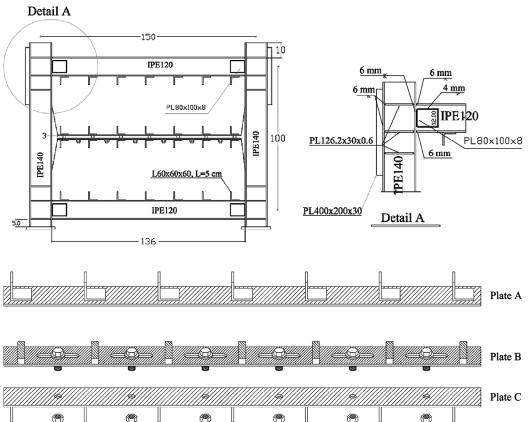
Geometria, setup di prova e dettaglio delle guide a taglio tra i tamponamenti (Mohammadi e Akrami, 2010).
